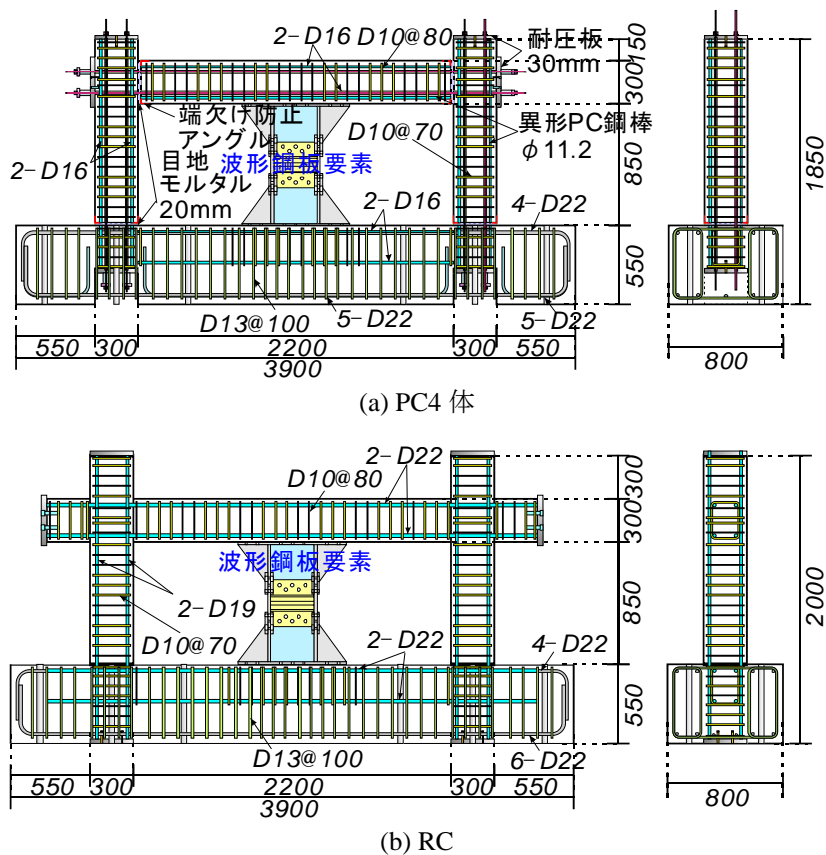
試験体寸法・配筋詳細 (単位: mm)
